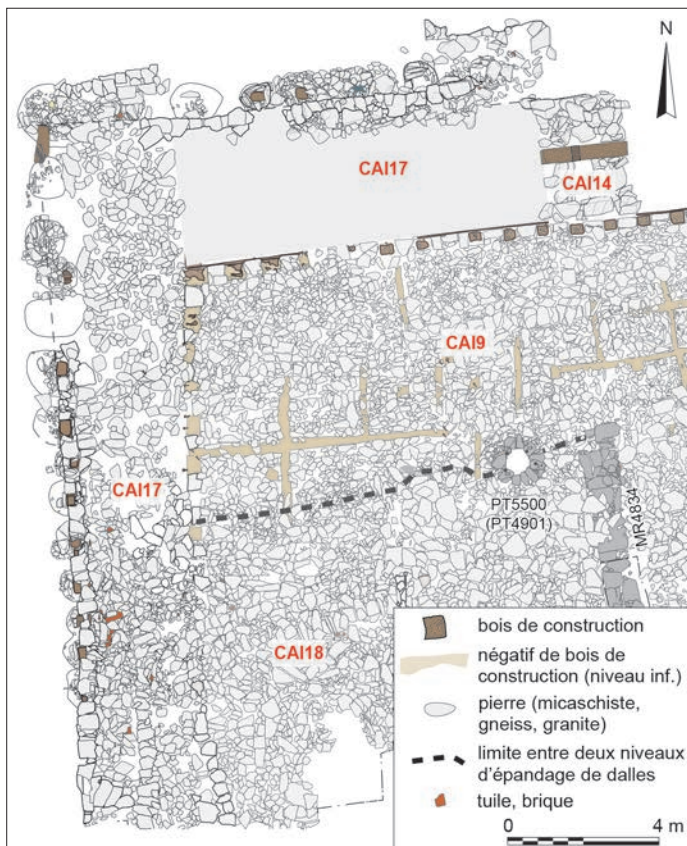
Plan des caissons n°s 14 et 17, construits au 1^{er} s.apr. J.-C. pour agrandir et conforter le premier caisson n° 9 (DAO: J. Mouchard, M. Yacger).
